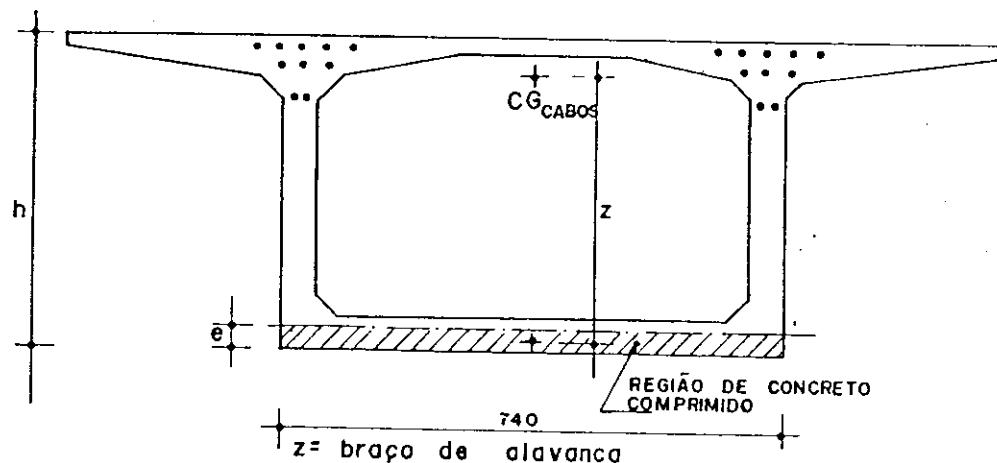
DETERMINAÇÃO DO BRAÇO DE ALAVANCA EM S10
